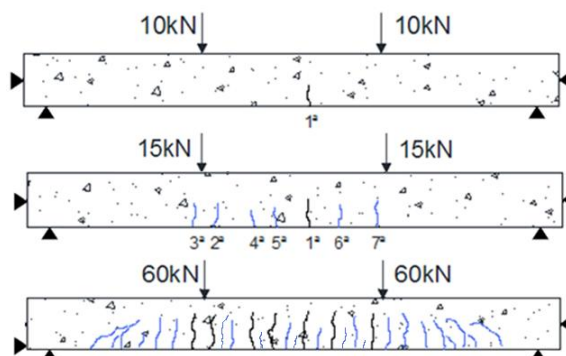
Formação e evolução das fissuras da Viga1.
